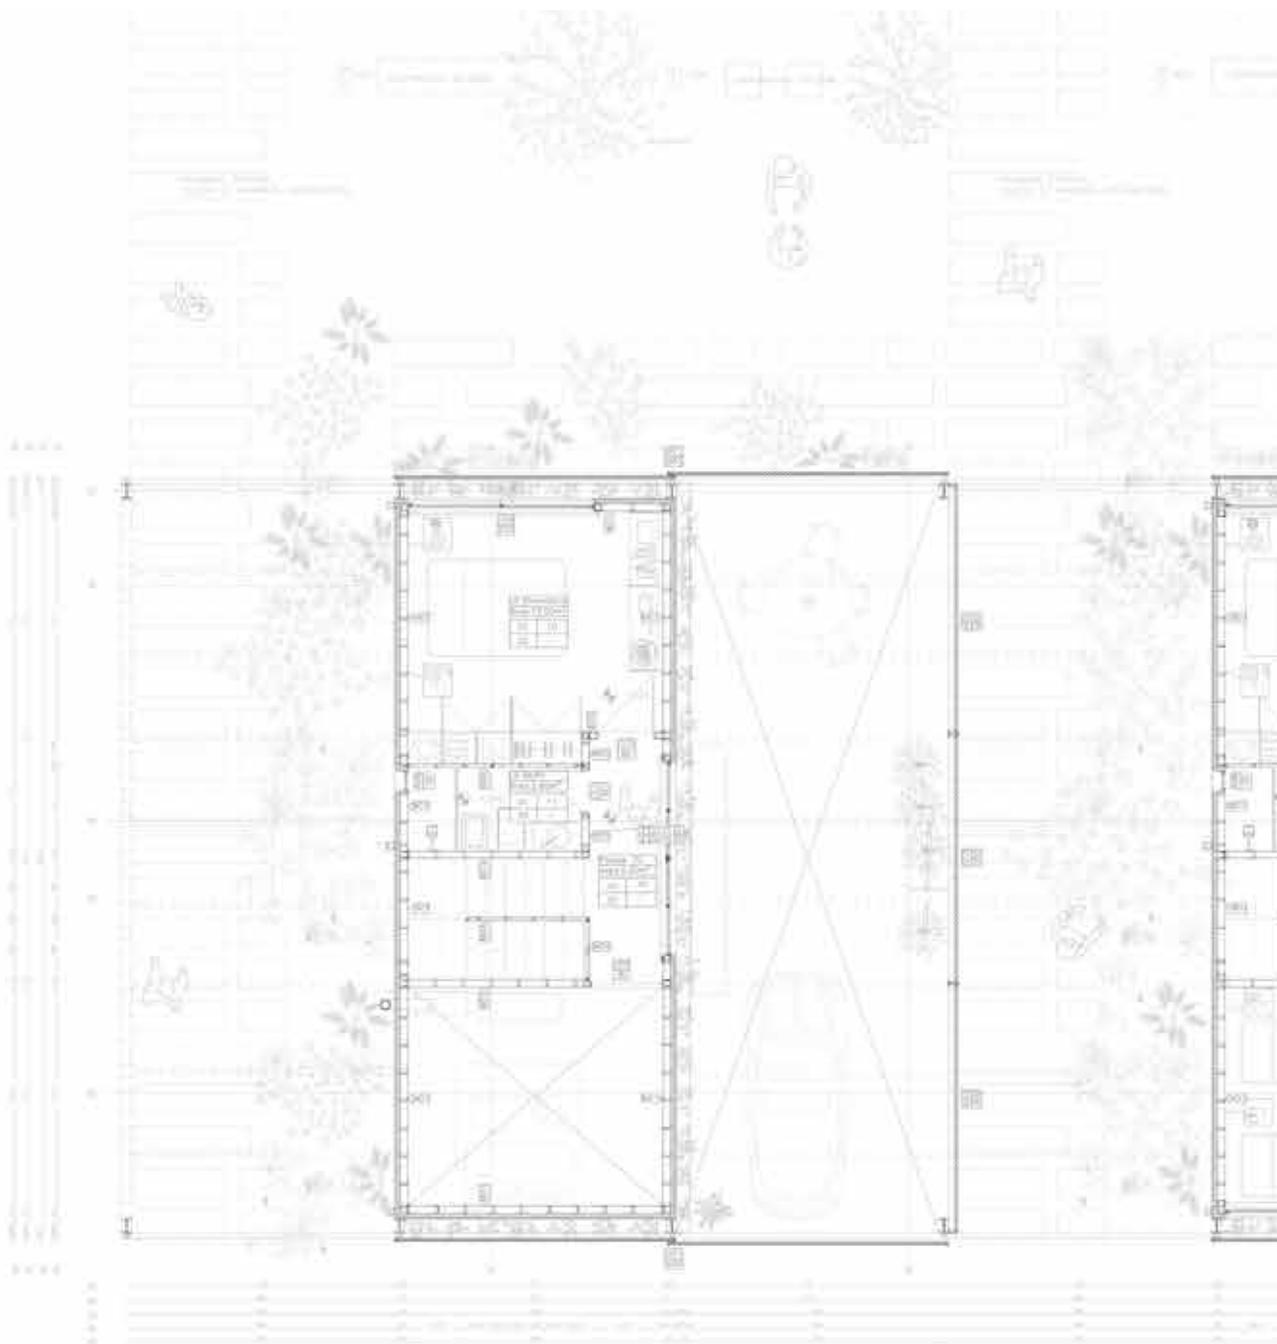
Planta baja tres tipologías. Dibujo del autor.
